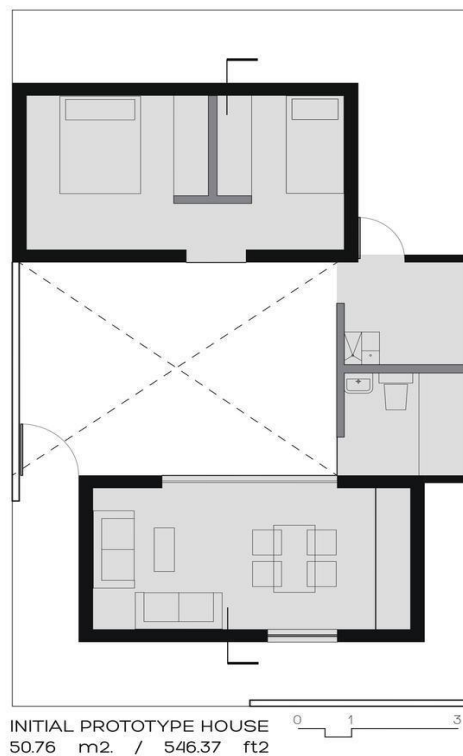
Planta Arquitectonica. Fuente: (ArchDaily, 2015).
